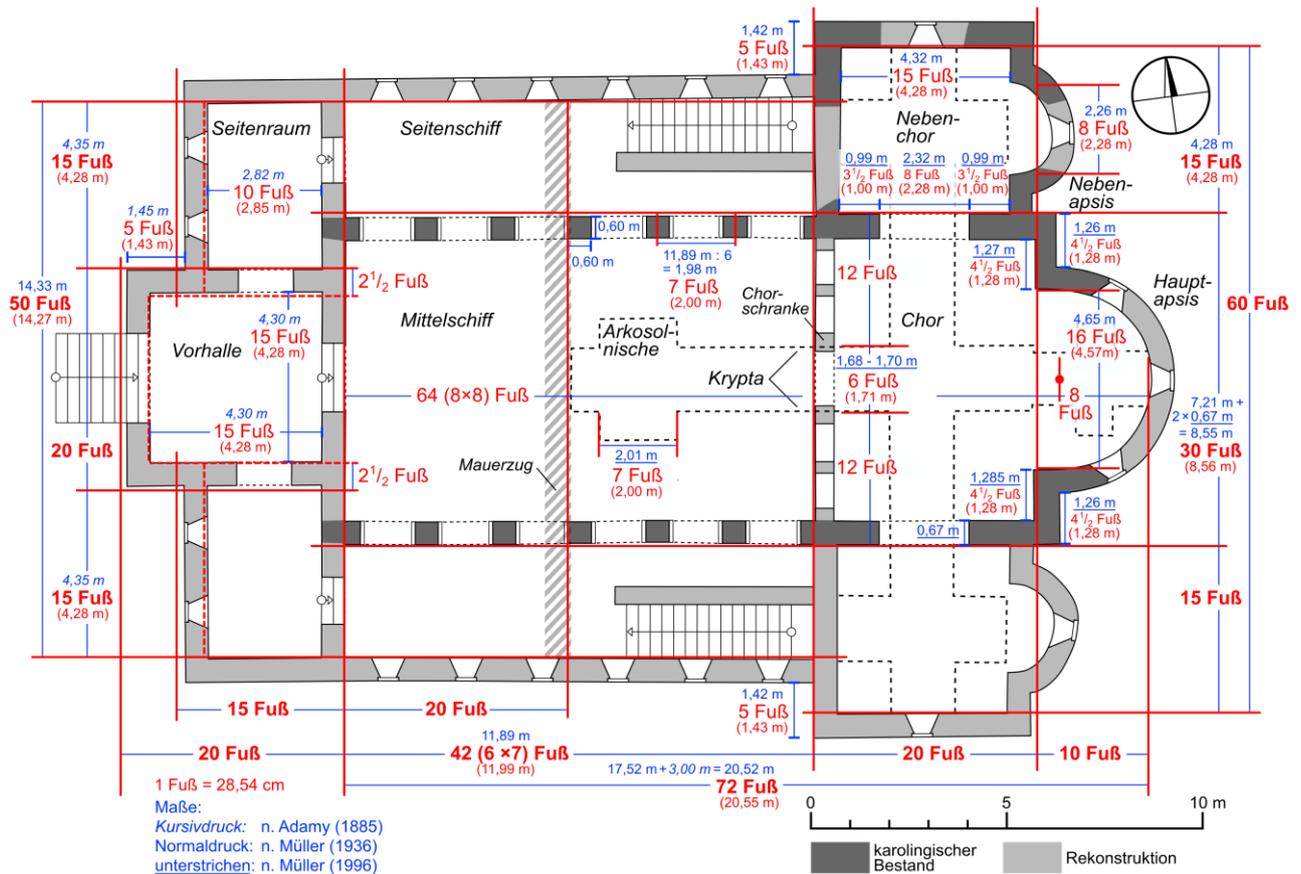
Die Maße am Grundriss der Einhardsbasilika
